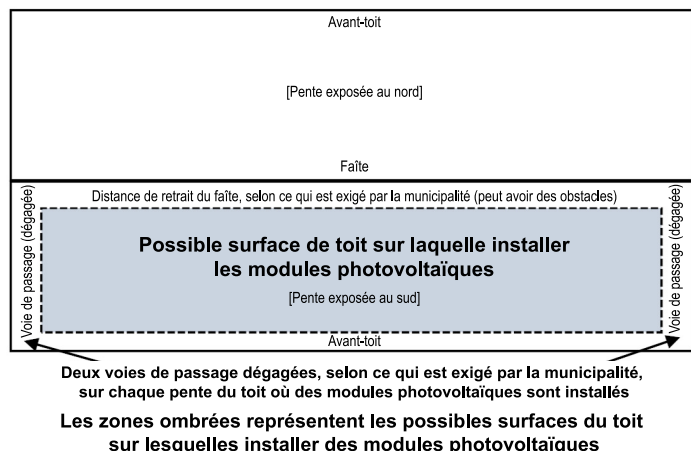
Exigences concernant la distance de retrait du faîte et la voie de passage pour un toit à pignon
